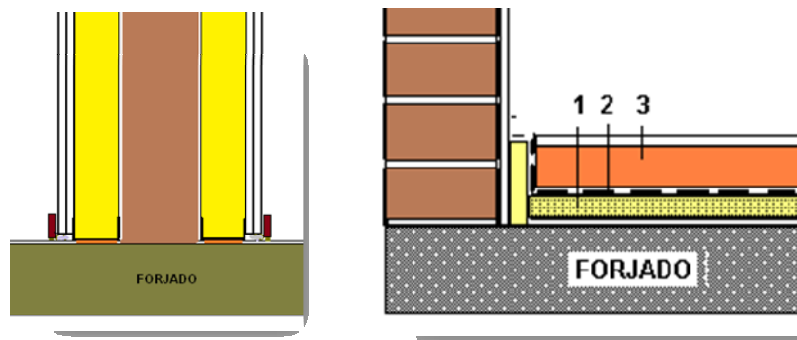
Sistemas de incremento de aislamiento en la construcción, vertical y horizontal.
